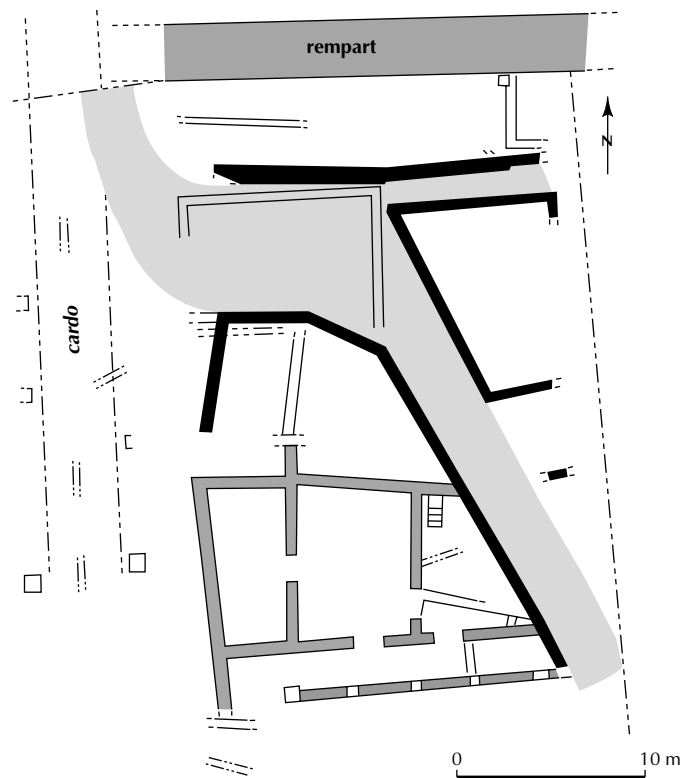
Arles (Bouches-du-Rhône). Plan de la maison tardive sur le site de l'Esplanade (d'après Heijmans, 2004a, p. 352, fig. 209).
